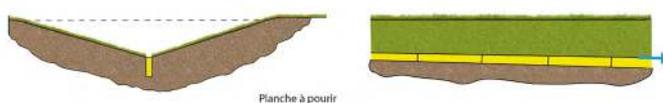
schéma d'une coupe en travers et coupe en long de noue avec planche à pourrir
